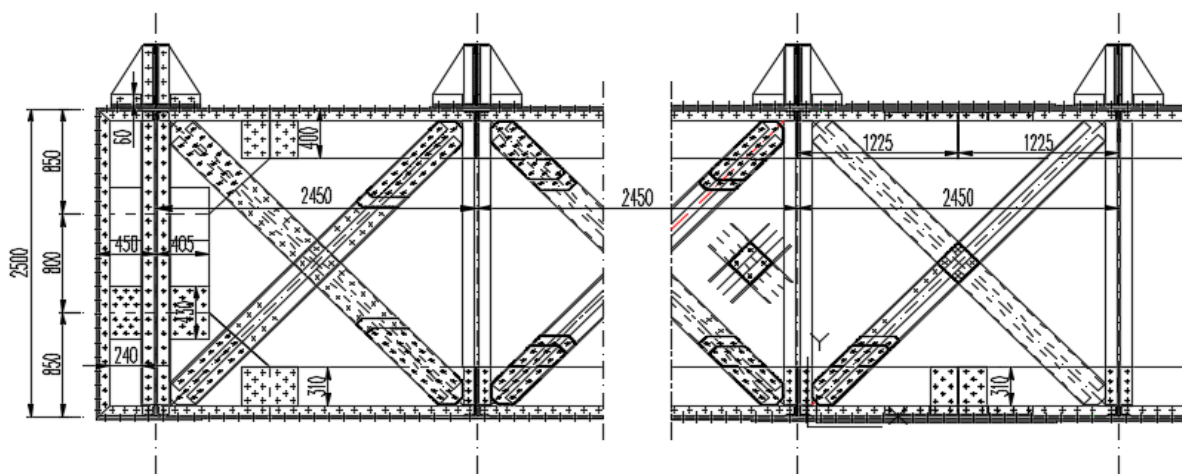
Vue en élévation de la poutre en treillis du pont PK 196+706
